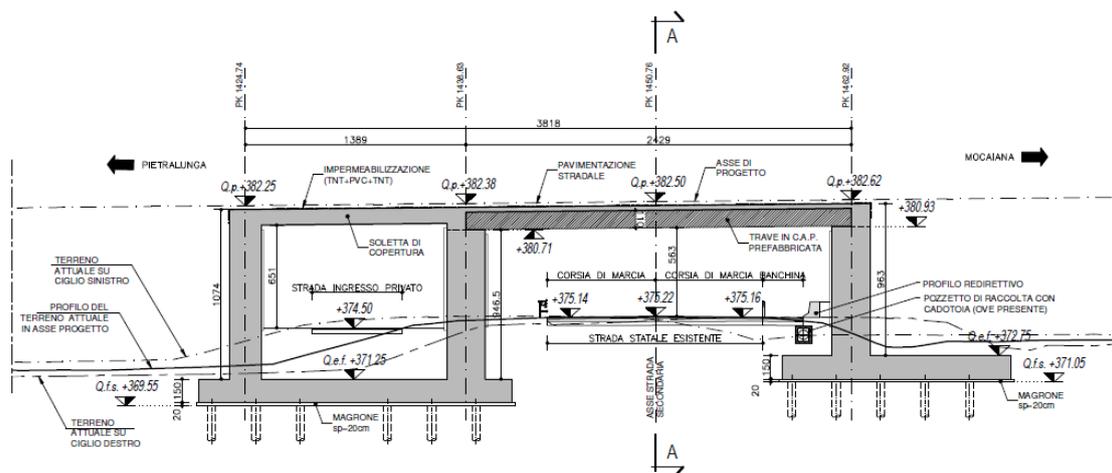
SEZIONE LONGITUDINALE SOTTOPASSO PK 1+450.74
